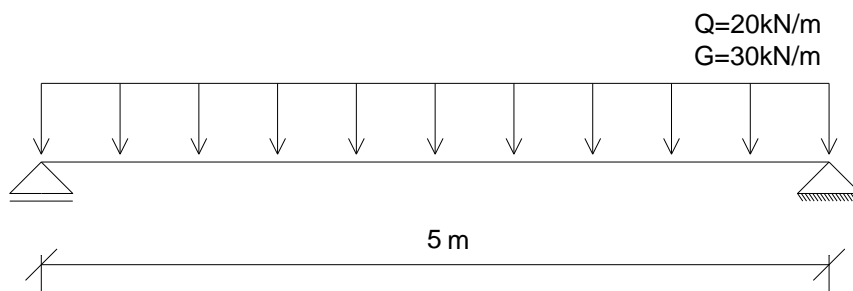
Viga com 5m de comprimento e de secção 0,25×0,5m².
